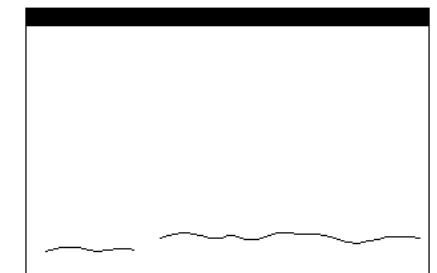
Fissuras horizontais por efeito da umidade do solo.
